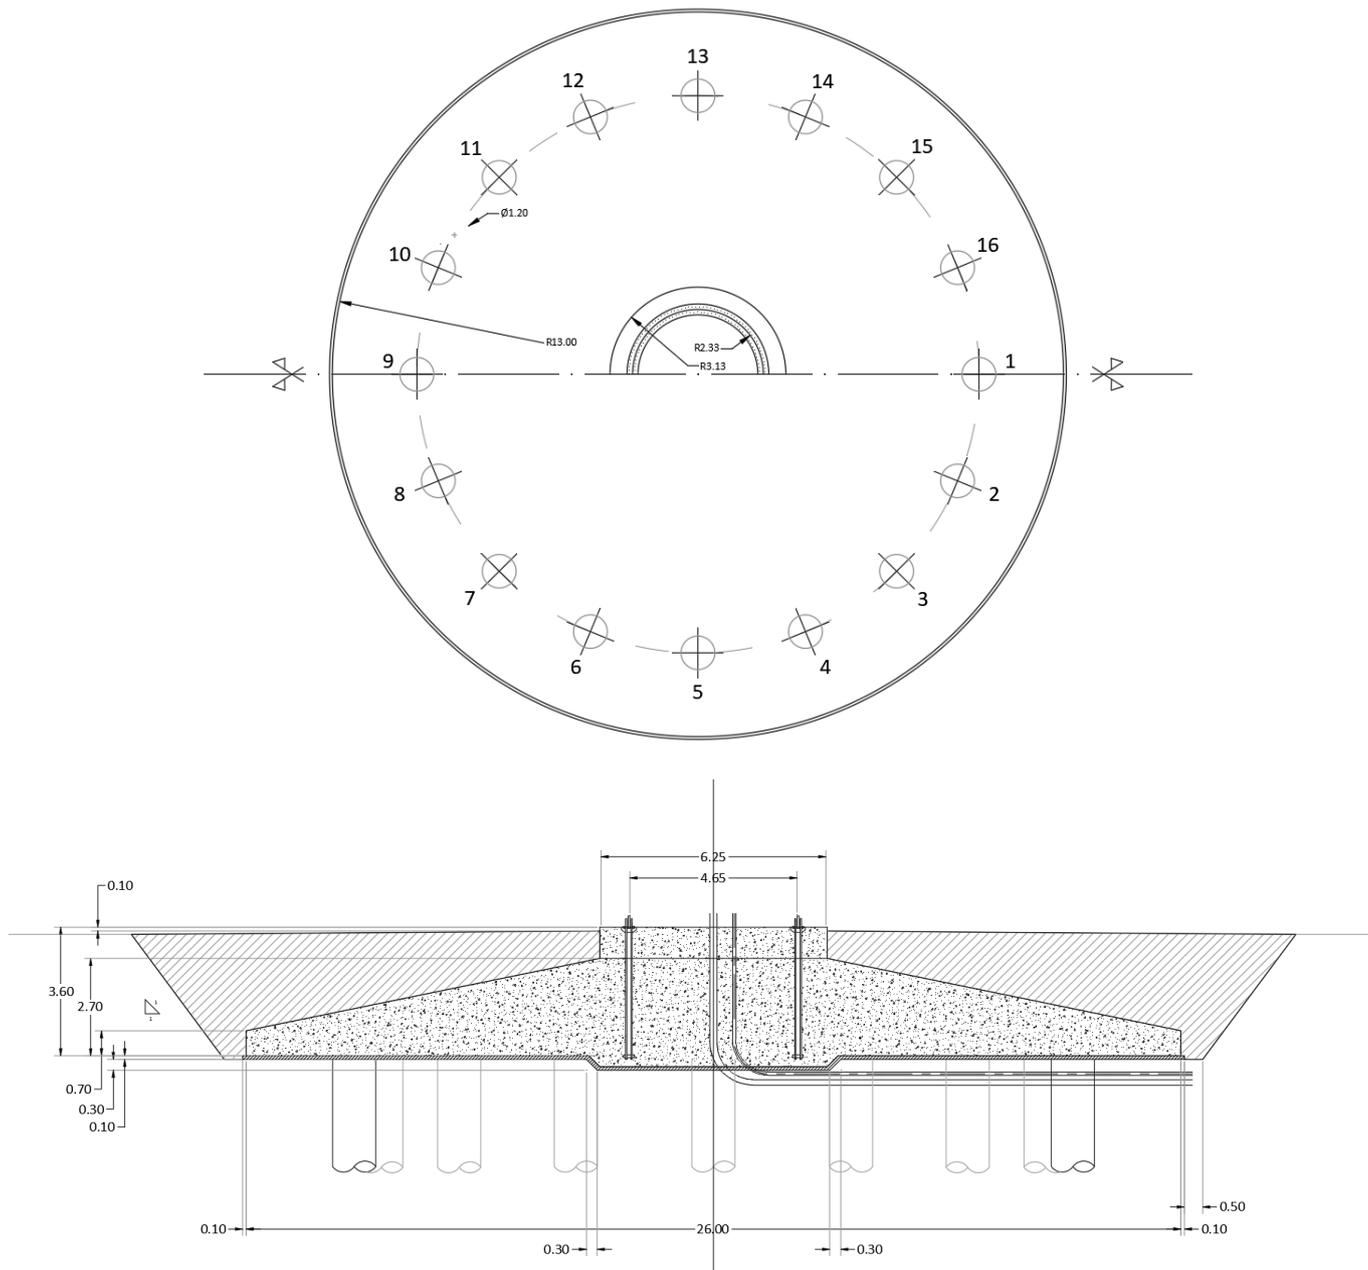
tipologico fondazione aerogeneratore: pianta e sezione
